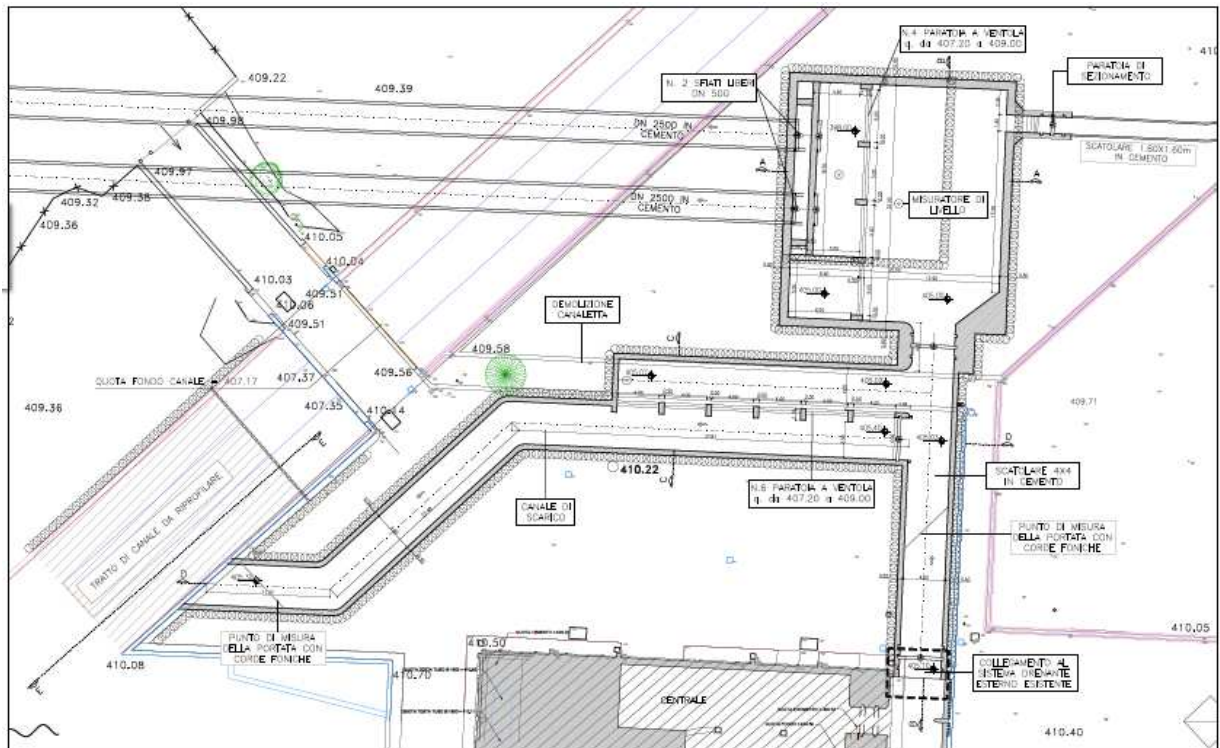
STRALCIO PLANIMETRICO DELL'INTERVENTO SCALA 1:200
